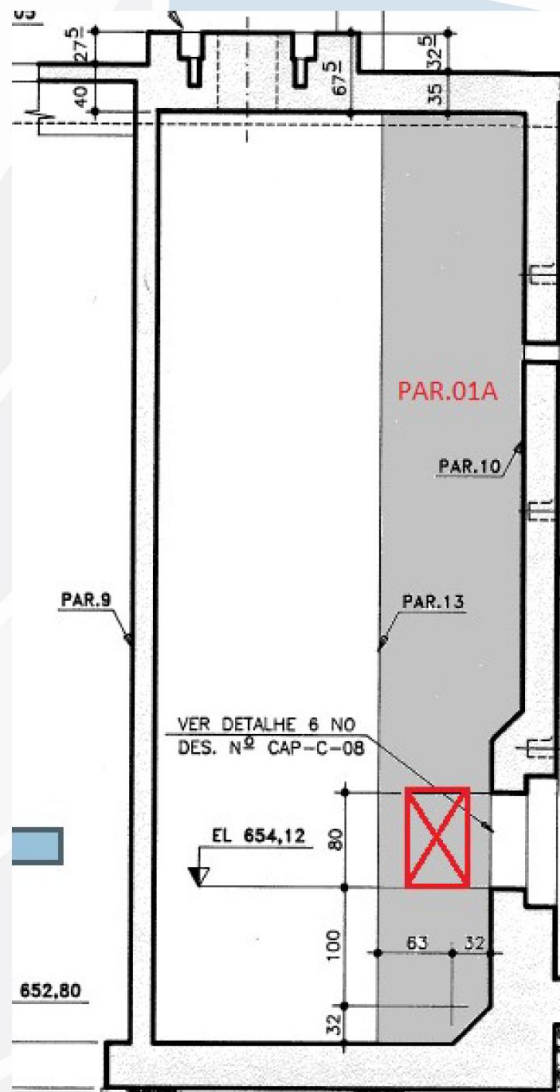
Detalhe em vista da PAR.01A a ser executada
